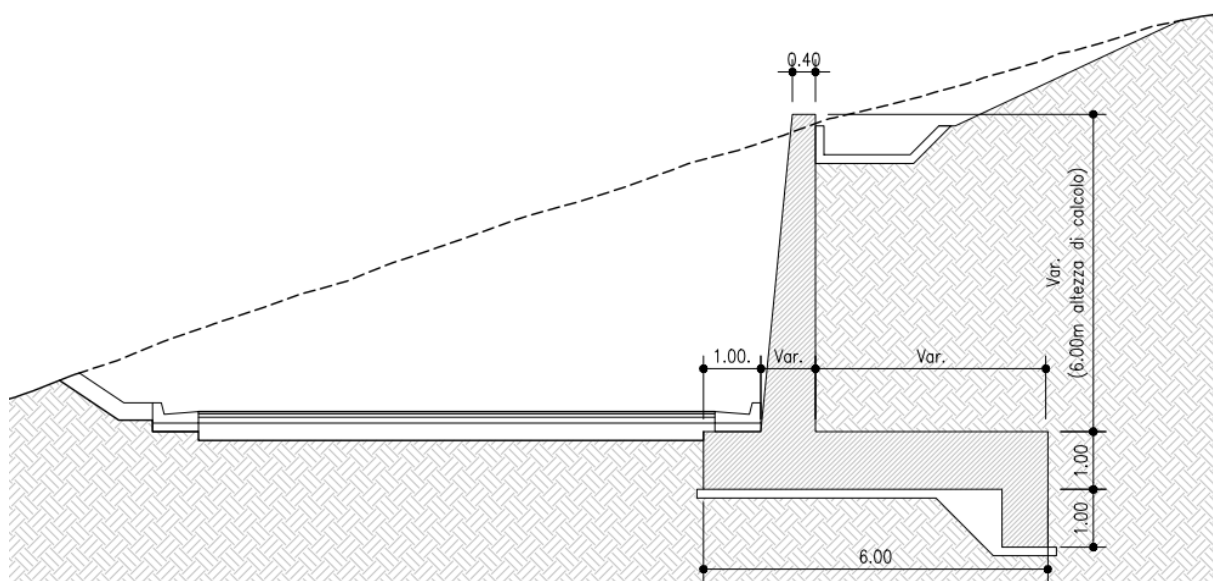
Muro ad L - Sezione trasversale - Conci da 2 a 5
